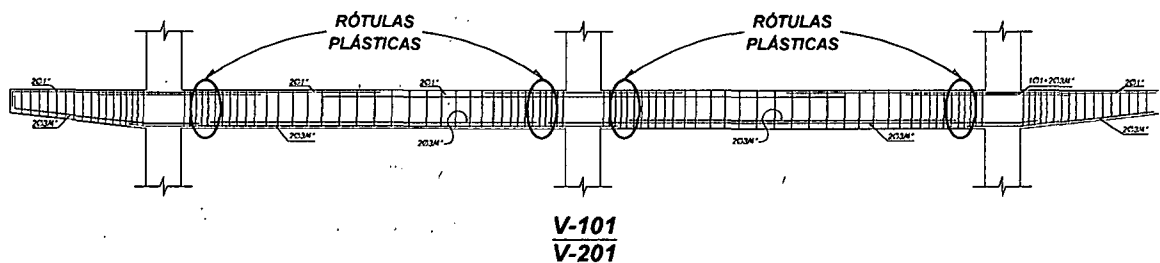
Ubicación de las rótulas a analizar en las vigas V-101 y V-201
